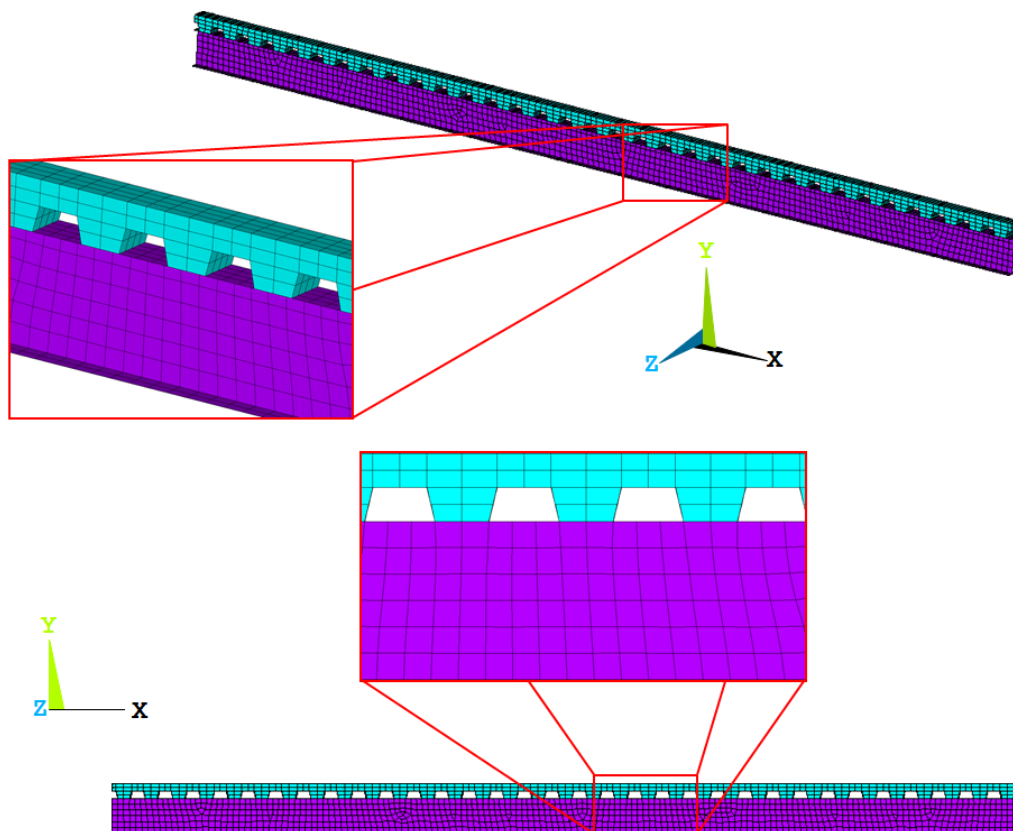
Ligação do perfil de aço com a laje de concreto.
